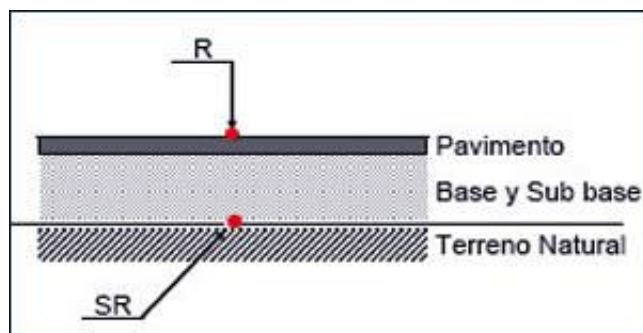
Sección de pavimento flexible. Pavimento flexible. Recuperada de:
